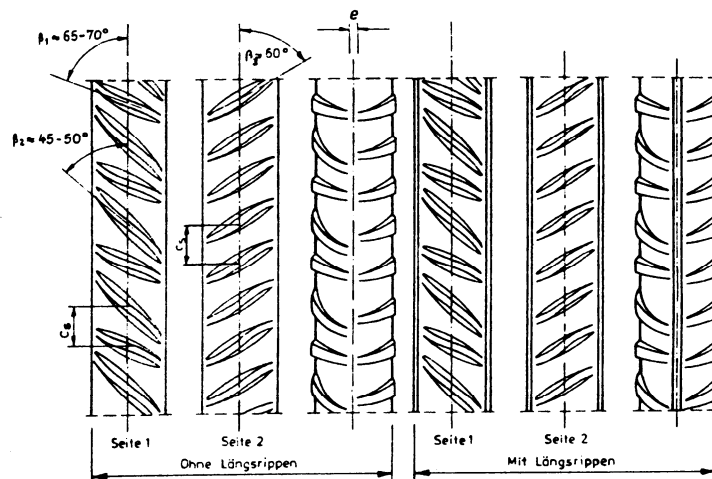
Nicht verwundener Betonstahl BSt 500 S mit und ohne Längsrippen
